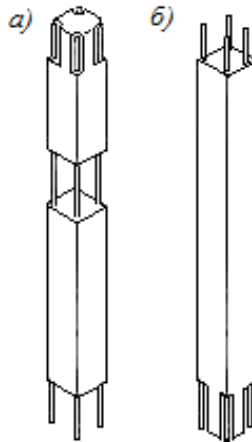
Типи залізобетонних безконсольних колон багатоповерхових виробничих будівель: *a* – з відкритою арматурою в рівнях перекриттів; *б* – з верхніми випусками арматури
